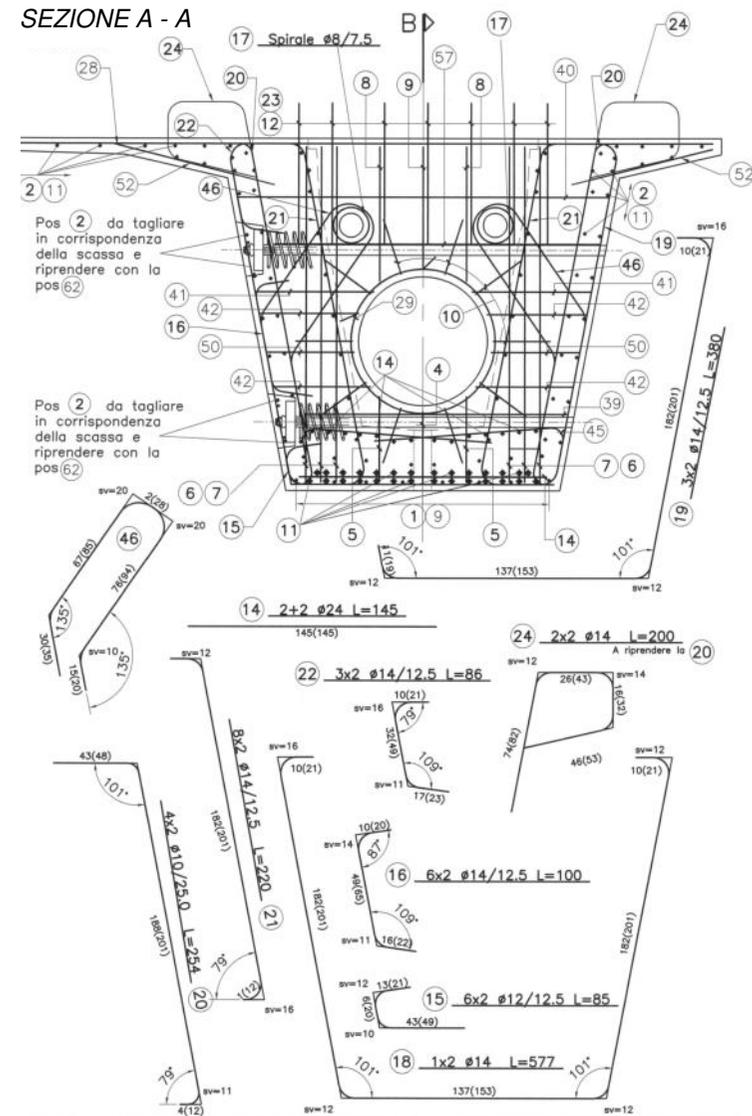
Esempio di armatura della testata di una trave pre-tesa a cassoncino: sezione trasversale
